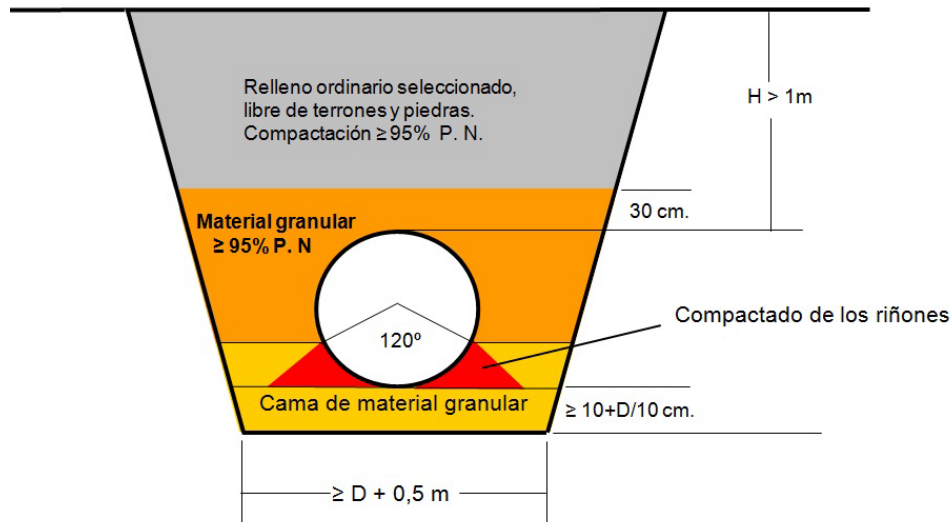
Esquema de tubería enterrada. Fuente: Construnario<sup>6</sup>.
